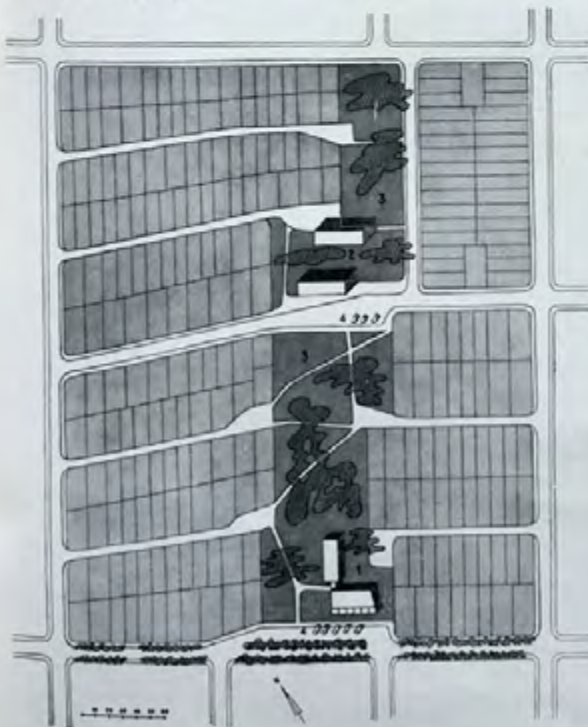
Schema planimetrico in scala 1 : 8.000 del piano di lottizzazione con sistema tradizionale.
